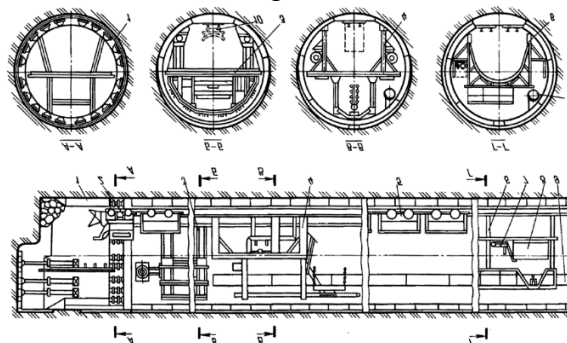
Немеханизированный проходческий щитовой комплекс
